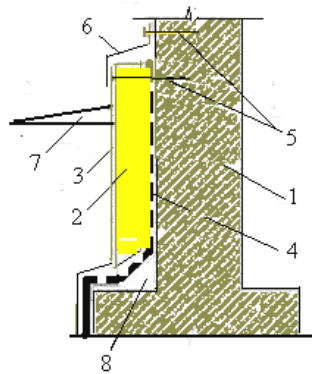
Утепление стен подвала жестким утеплителем снаружи:
